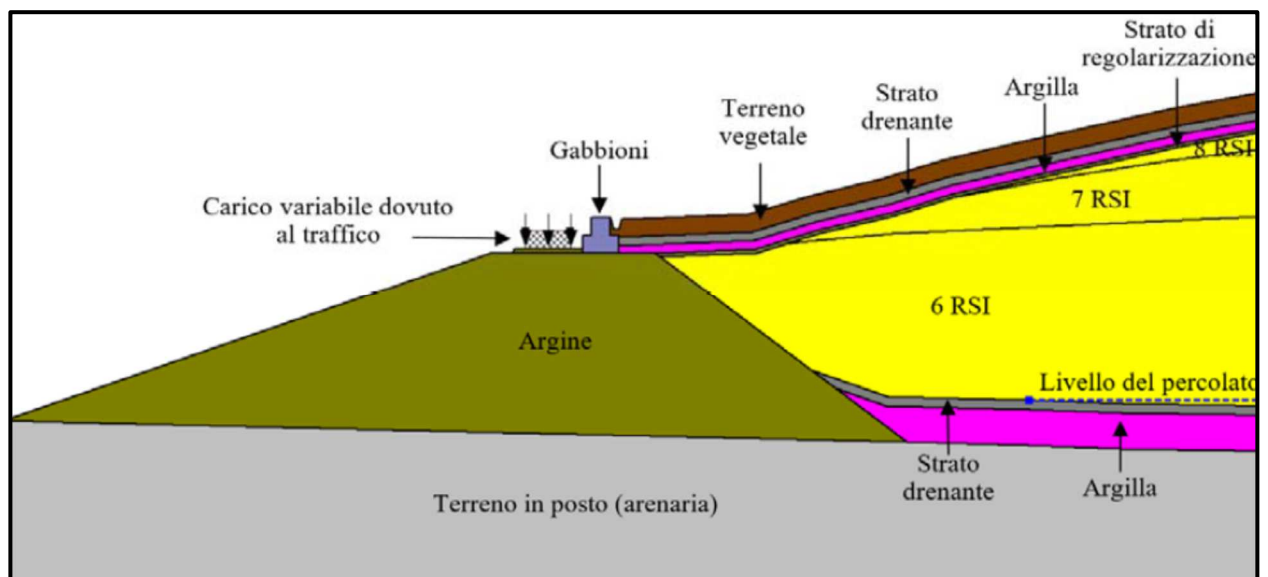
/II – Sezione A-A' – Sponda nord-est - Particolare 1
